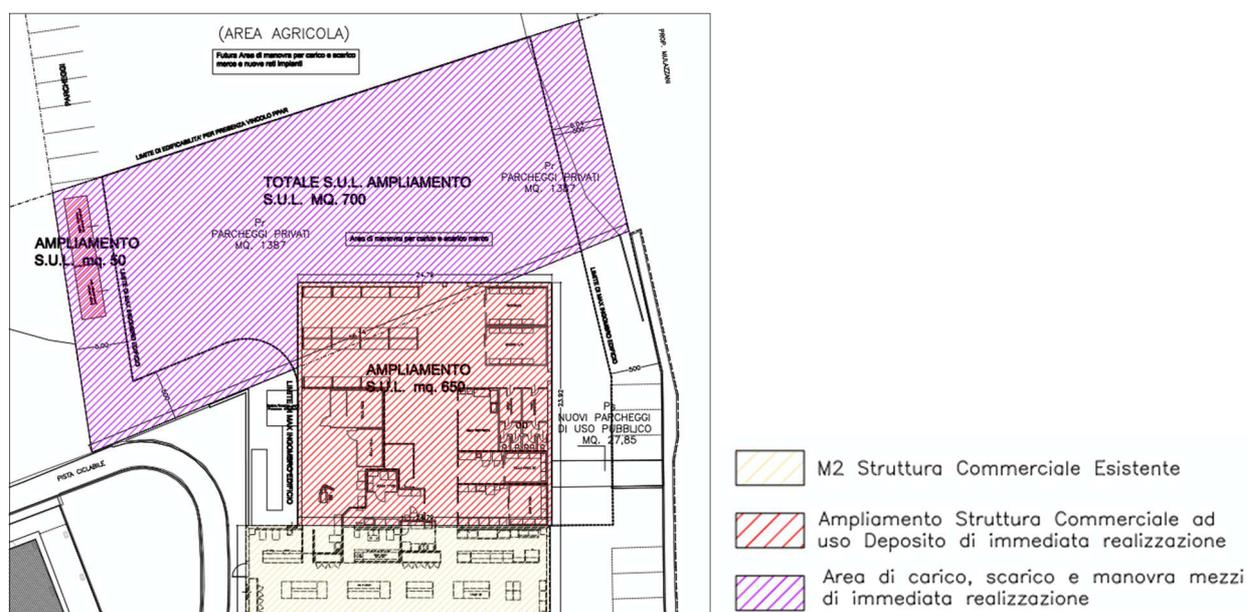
progetto proposta di variante (da Planimetria generale intervento)
